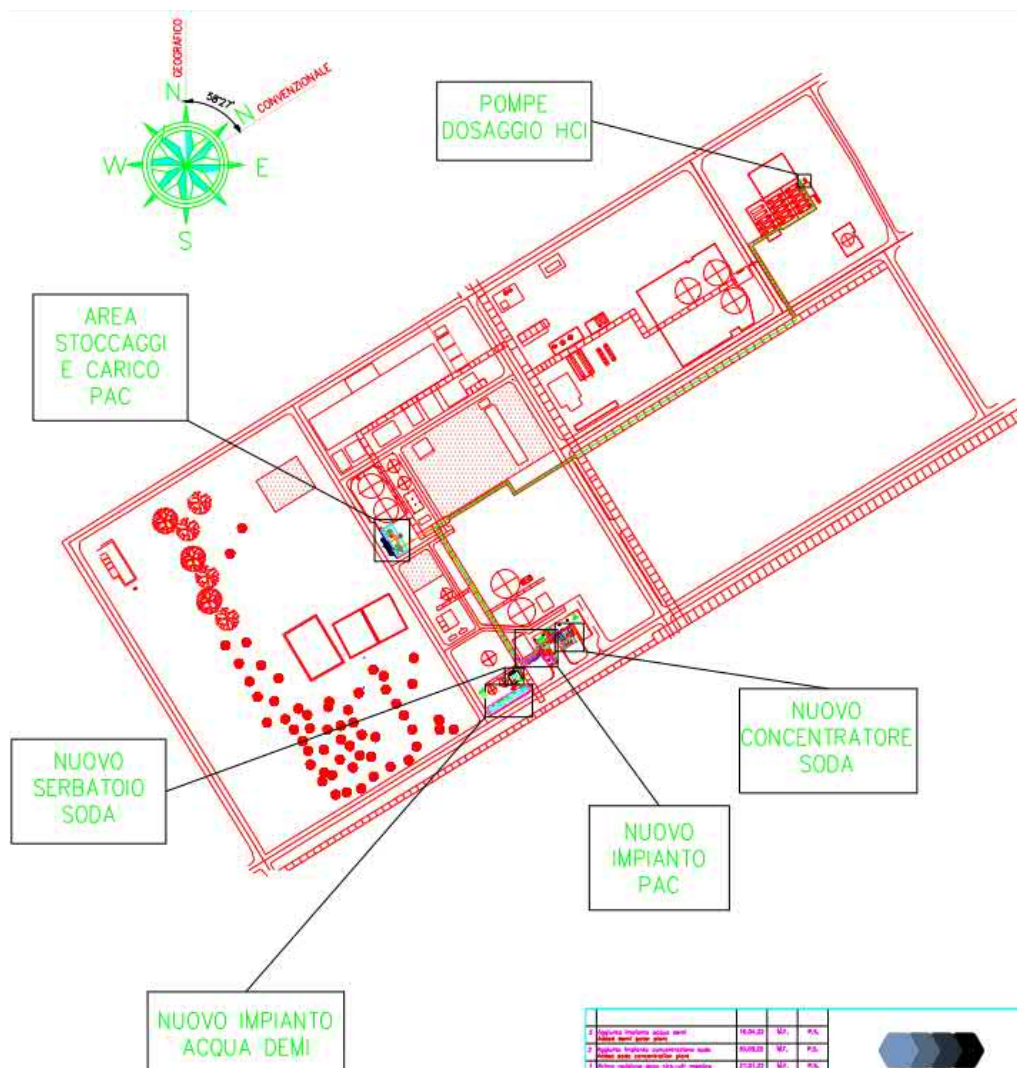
Localizzazione degli interventi in progetto nel layout generale dell'impianto
